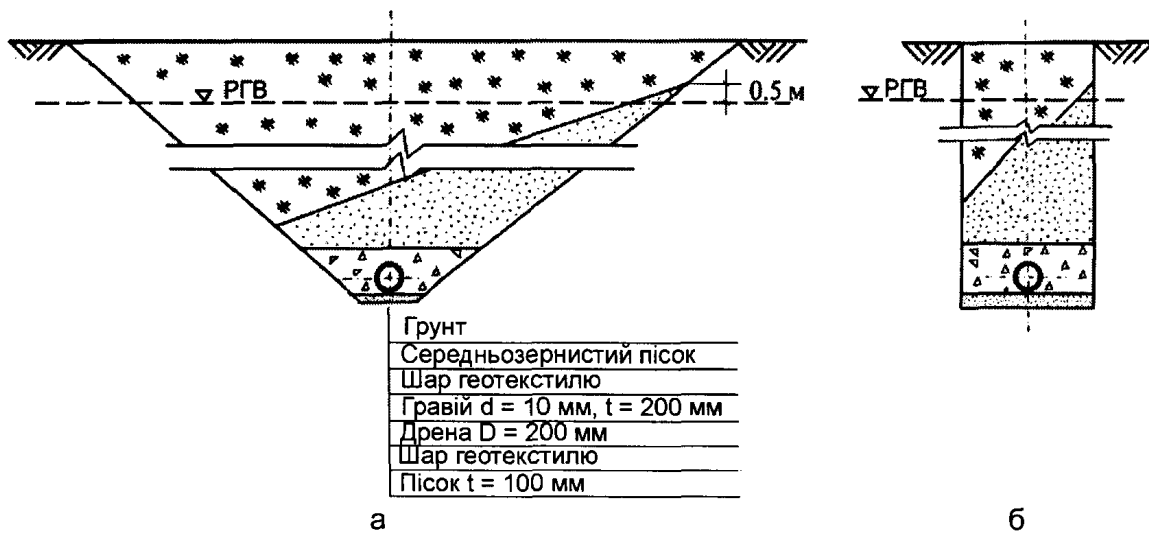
Конструкції дренажу з укисною (а) і закріпленою (б) траншеями
